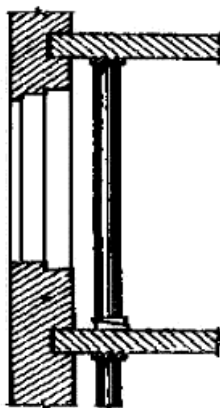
Вывешивание балок перекрытия, опирающихся на перекладываемый простенок
